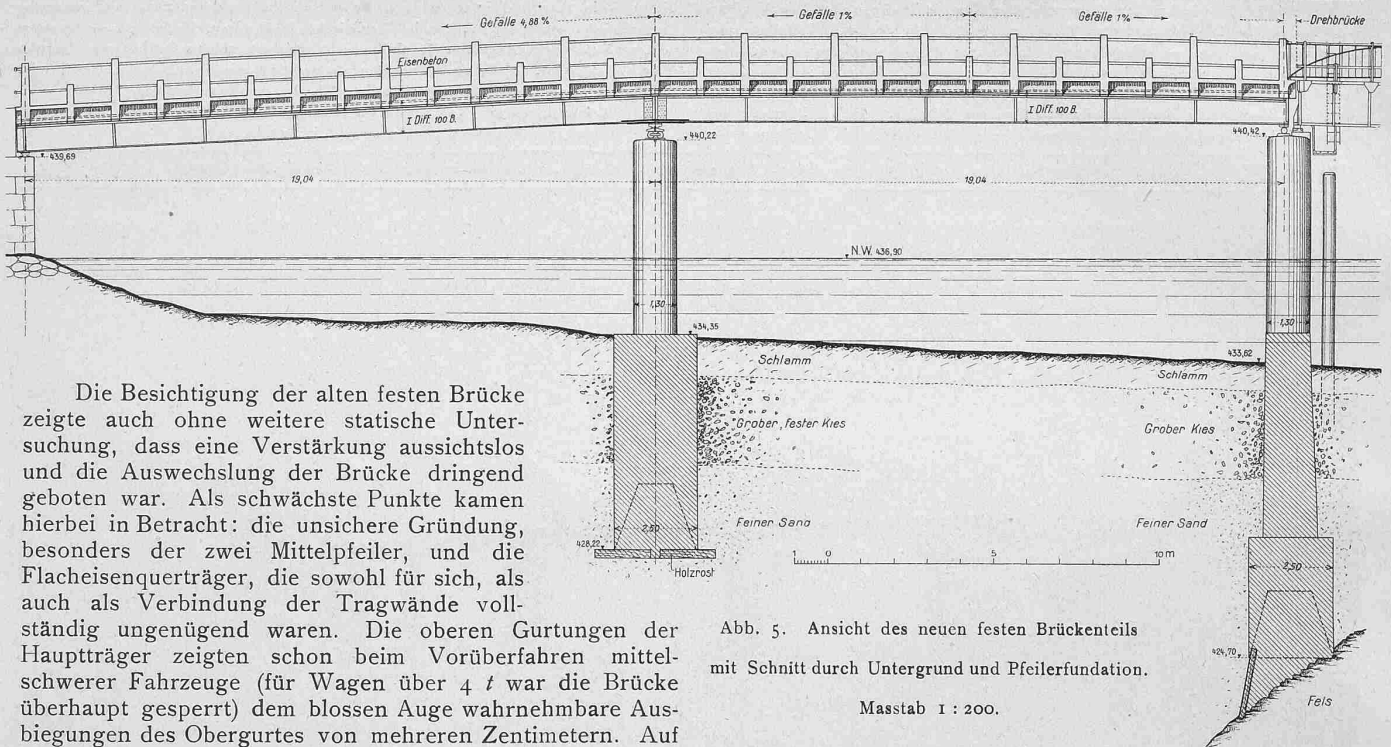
Ansicht des neuen festen Brückenteils mit Schnitt durch Untergrund und Pfeilerfundation.
